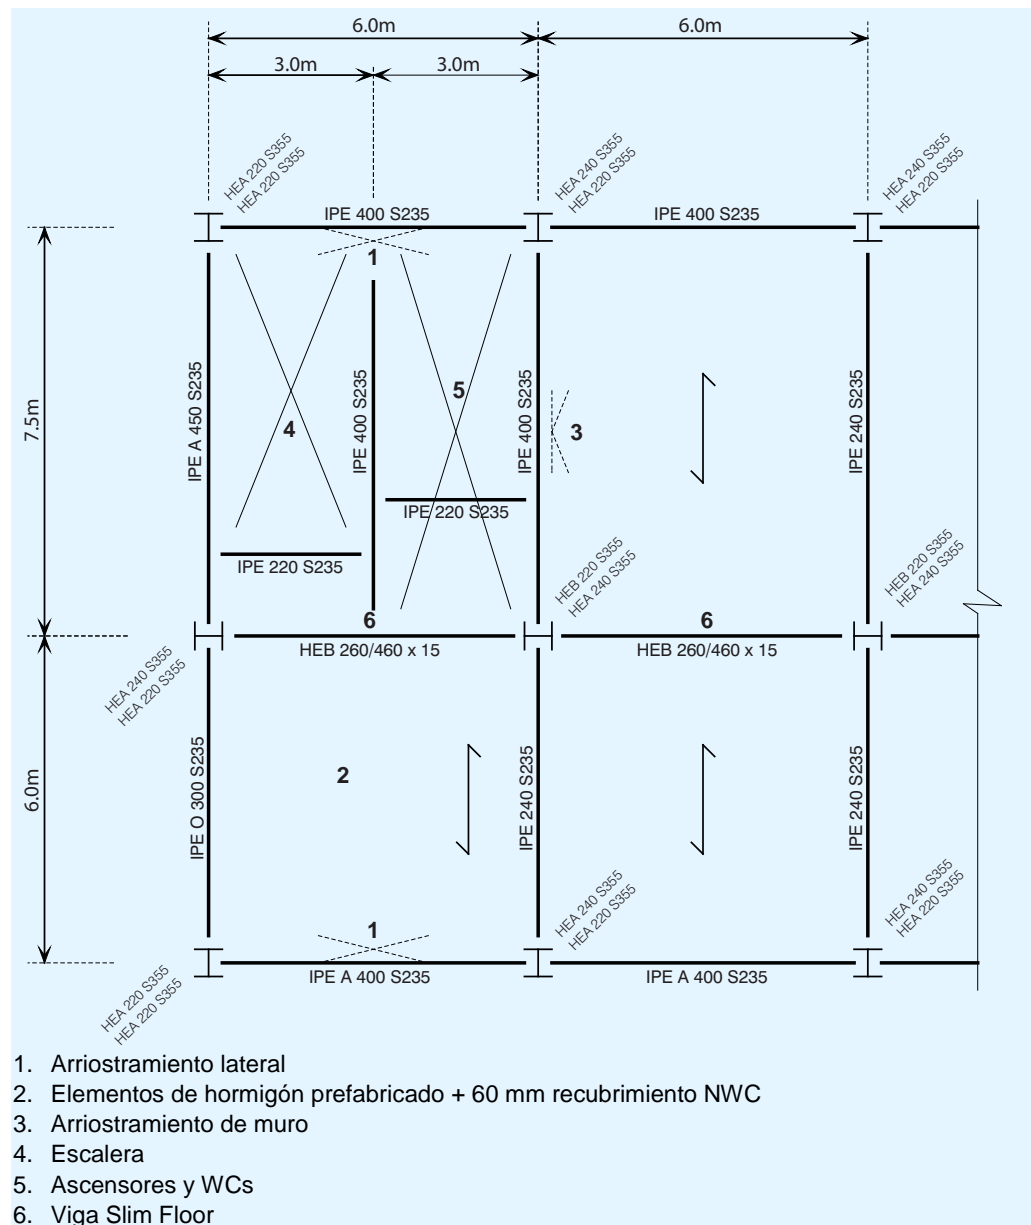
Viga integrada (viga Slim Floor) y placas de hormigón prefabricadas
